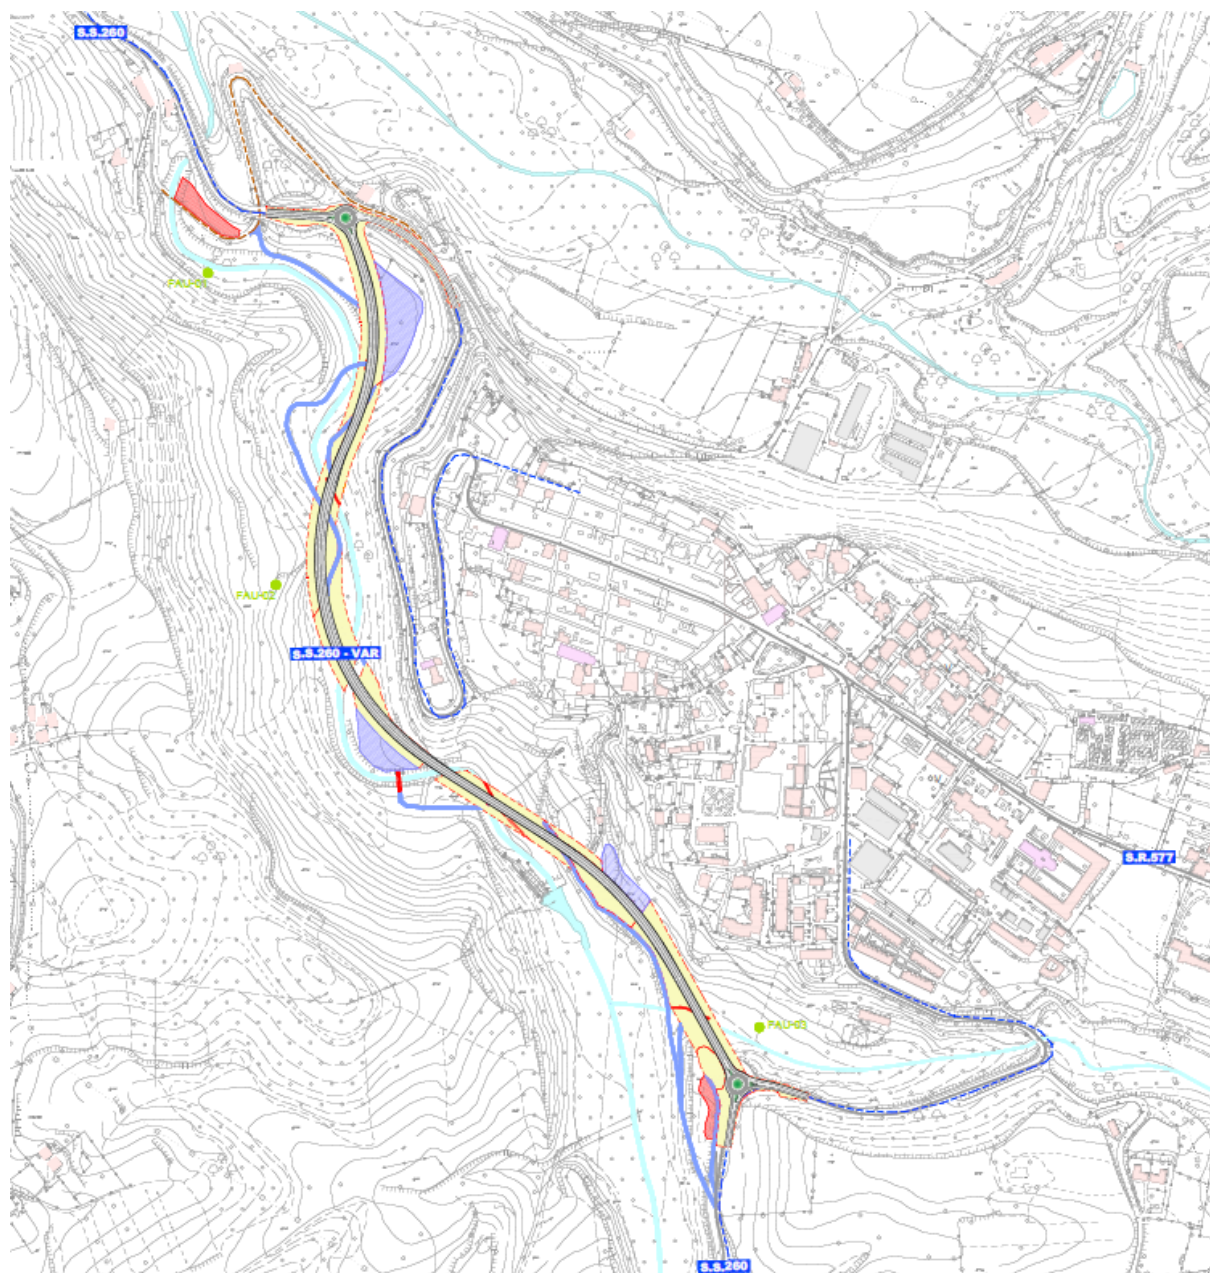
Planimetria punti di monitoraggio componente Fauna
